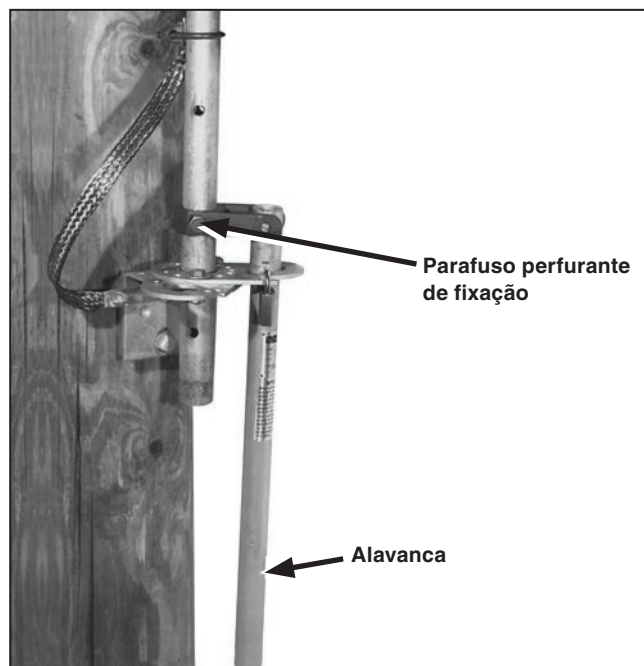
Conjunto de mancal de suporte inferior e conjunto da alavanca de operação.
